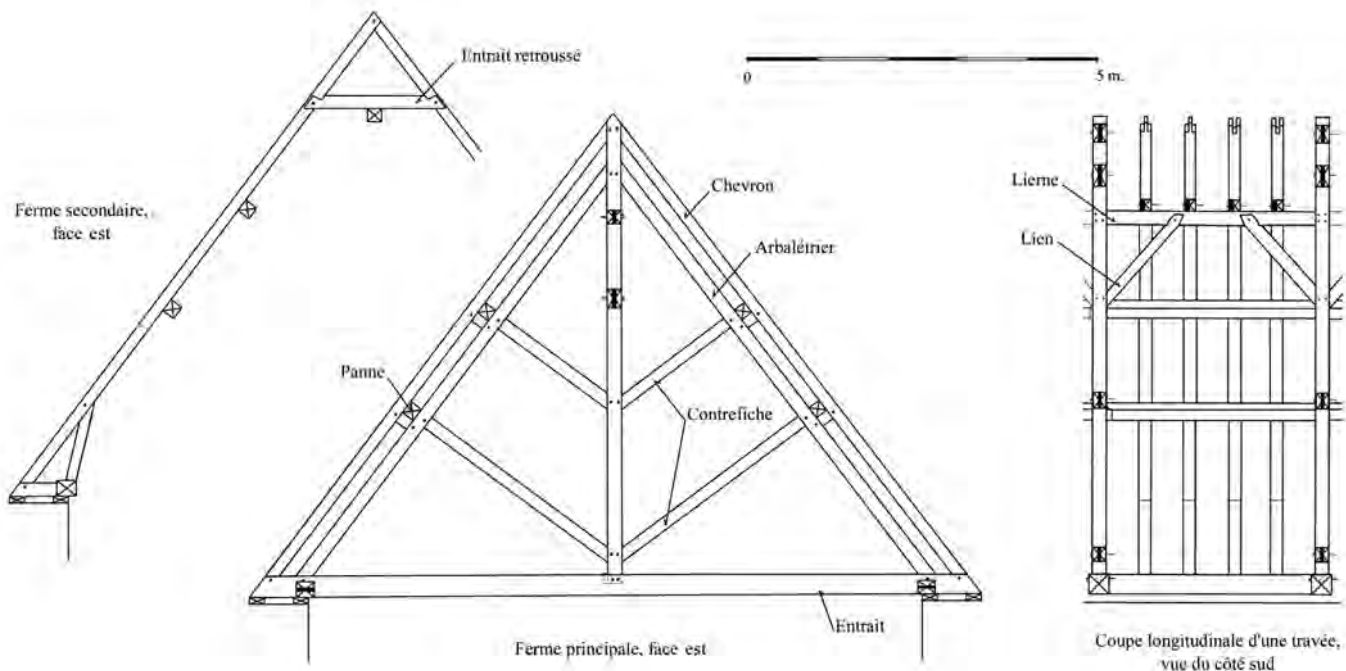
Fermes et coupe longitudinale d'une travée (1217-1223d).
